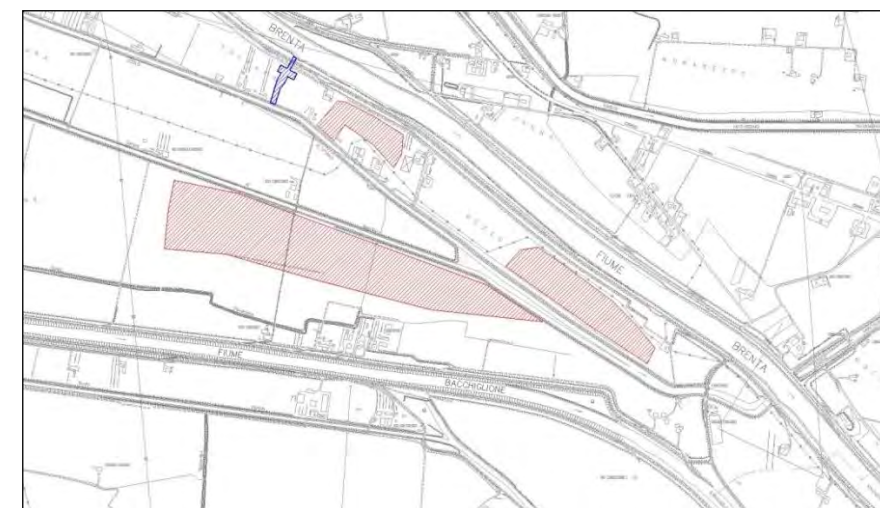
Individuazione in pianta delle soluzioni alternative 2 e 3
